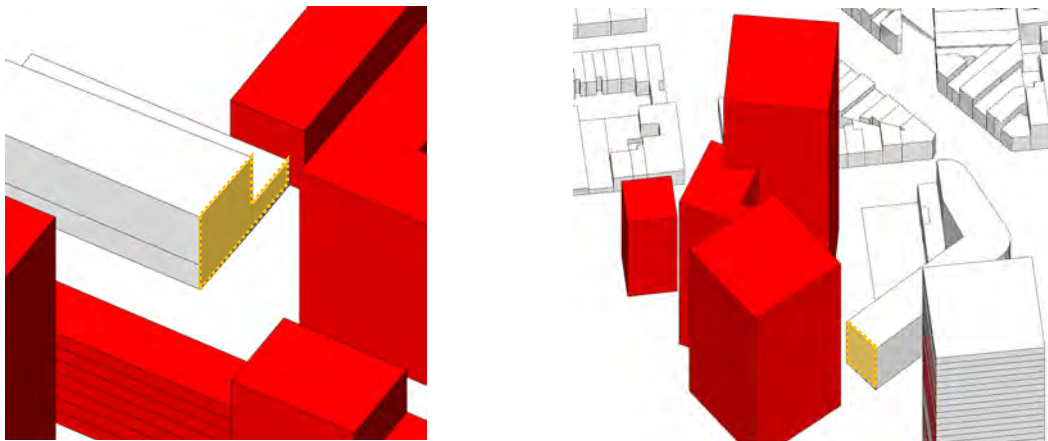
Onderlinge inkijk tussen de gebouwen van het blok Postsorteercentrum Fonsny: 3D-zicht (links) en plan (rechts) (ARIES, op een 3D-achtergrond van I'AUC, 2019)
